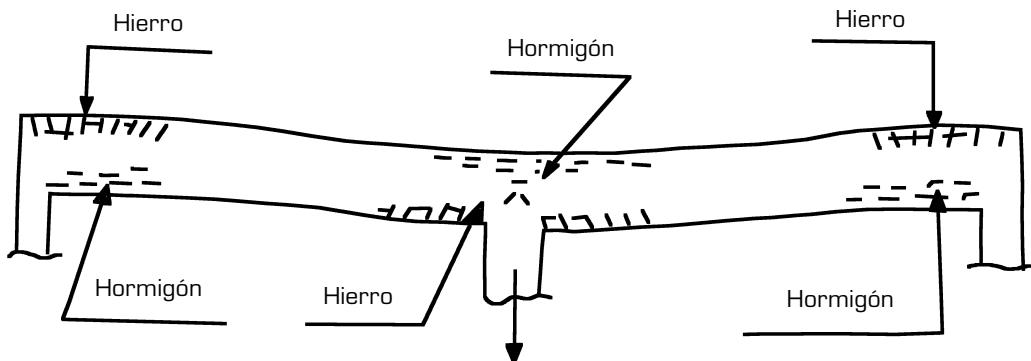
Losa de cubierta de hormigón armado afectada.
